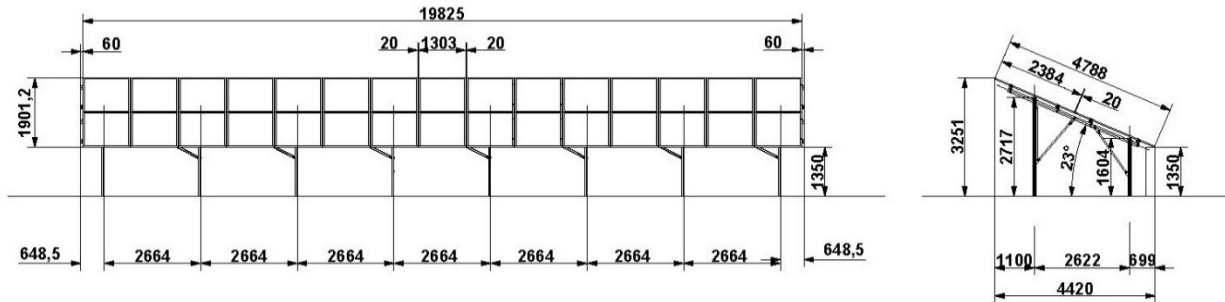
Struttura di ancoraggio. Pianta, pianta struttura e prospetto. Le strutture di sostegno saranno realizzate con profilati in acciaio
